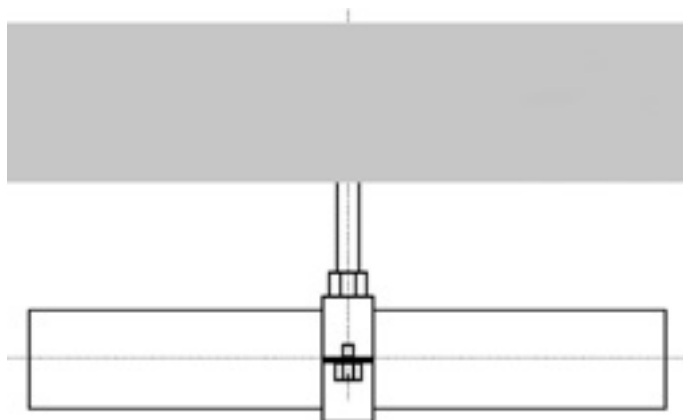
Крепление полиэтиленовой трубы при открытой прокладке с помощью стального хомута (опоры) с резиновой подкладкой.
